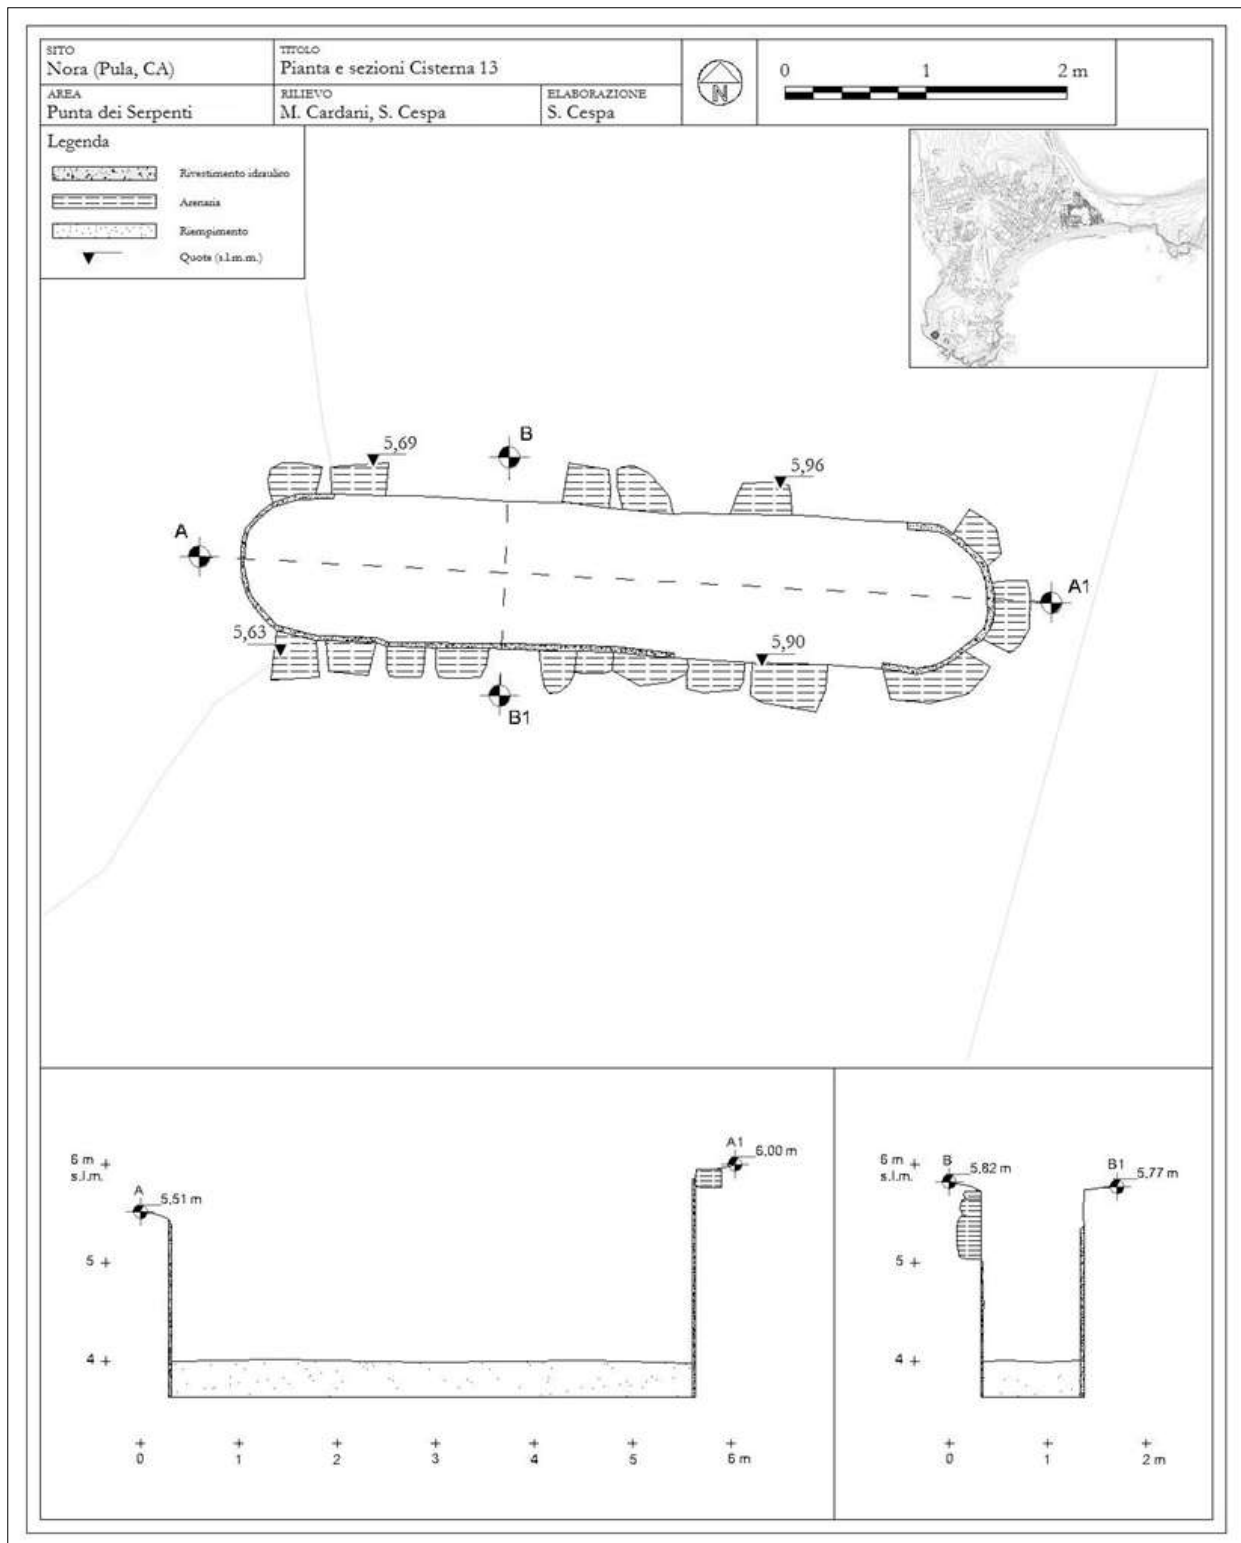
Pianta e sezioni della cisterna 13 (elaborazione dell'autore).
